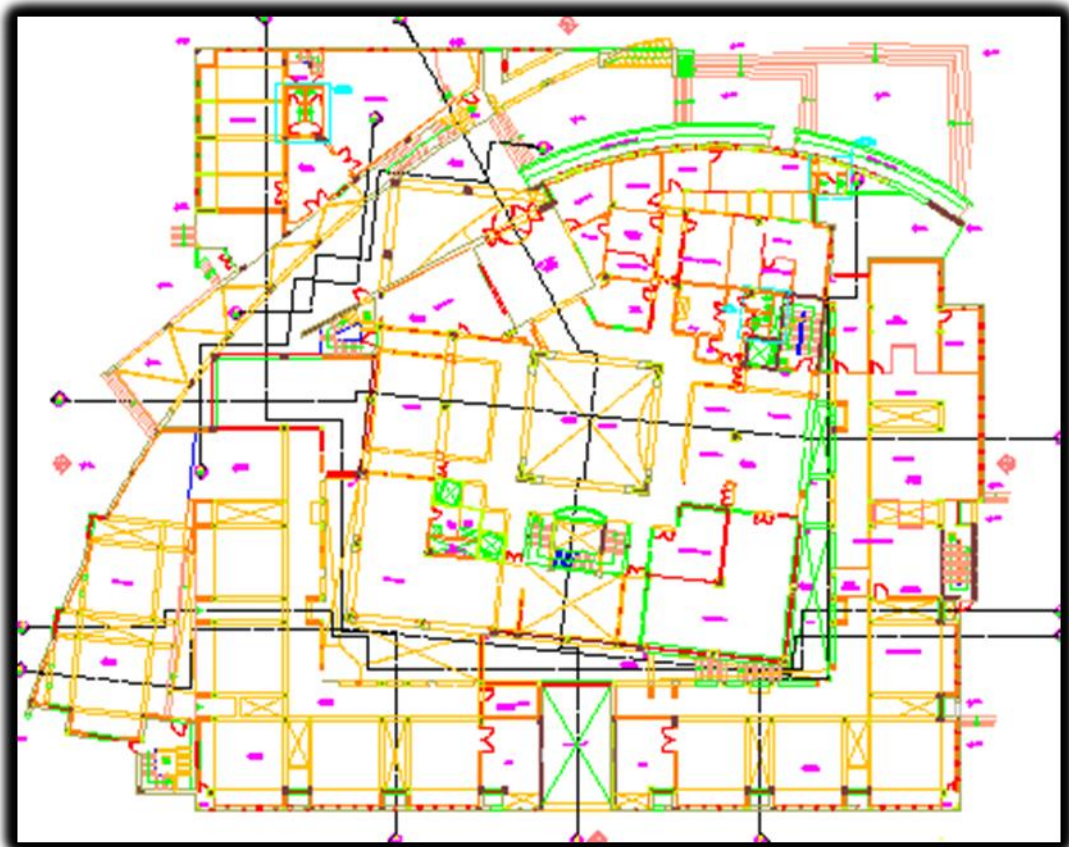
BASEMENT FLOOR PLAN
